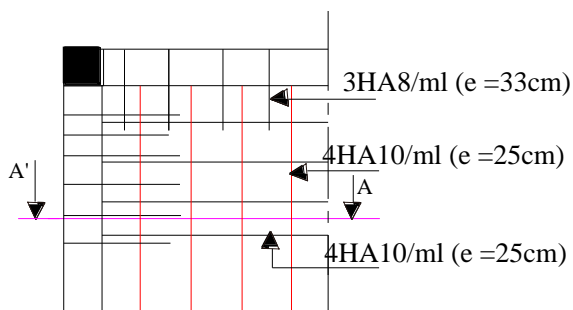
Schéma de ferrailage de la dalle du local machine.
